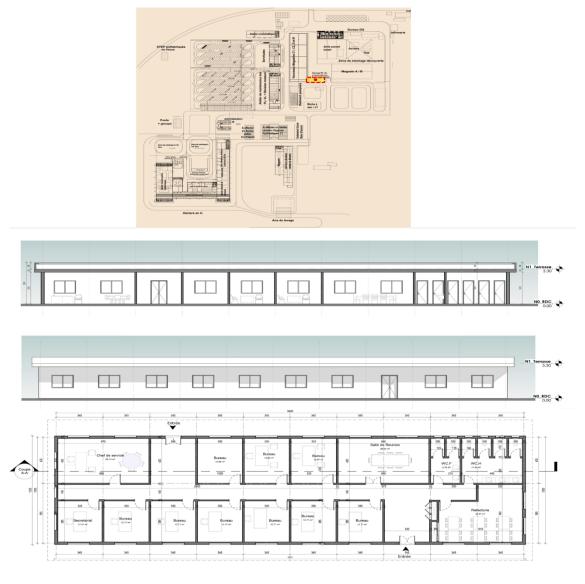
Bloc social-bureaux : Implantation, plan et élévations
